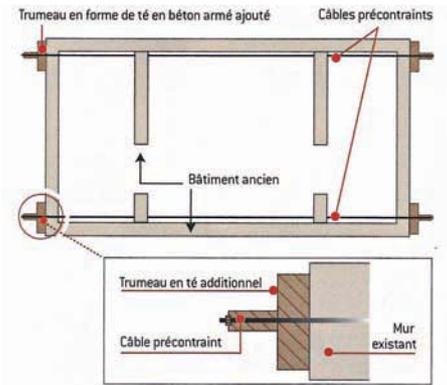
Exemple de renforcement par ajout de murs en béton à l'extérieur + serrage par précontraint (vue en plan)
